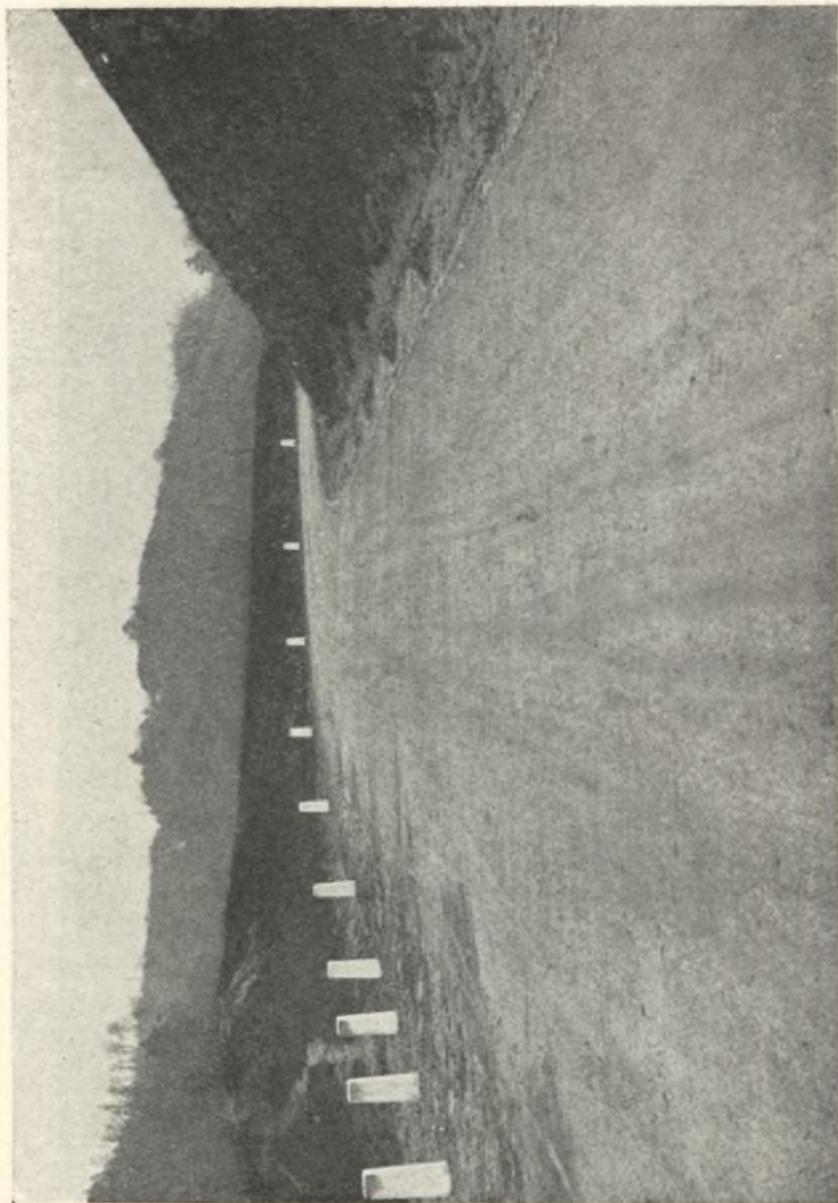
Betonstrecke der Wahntalstraße bei Siegburg
